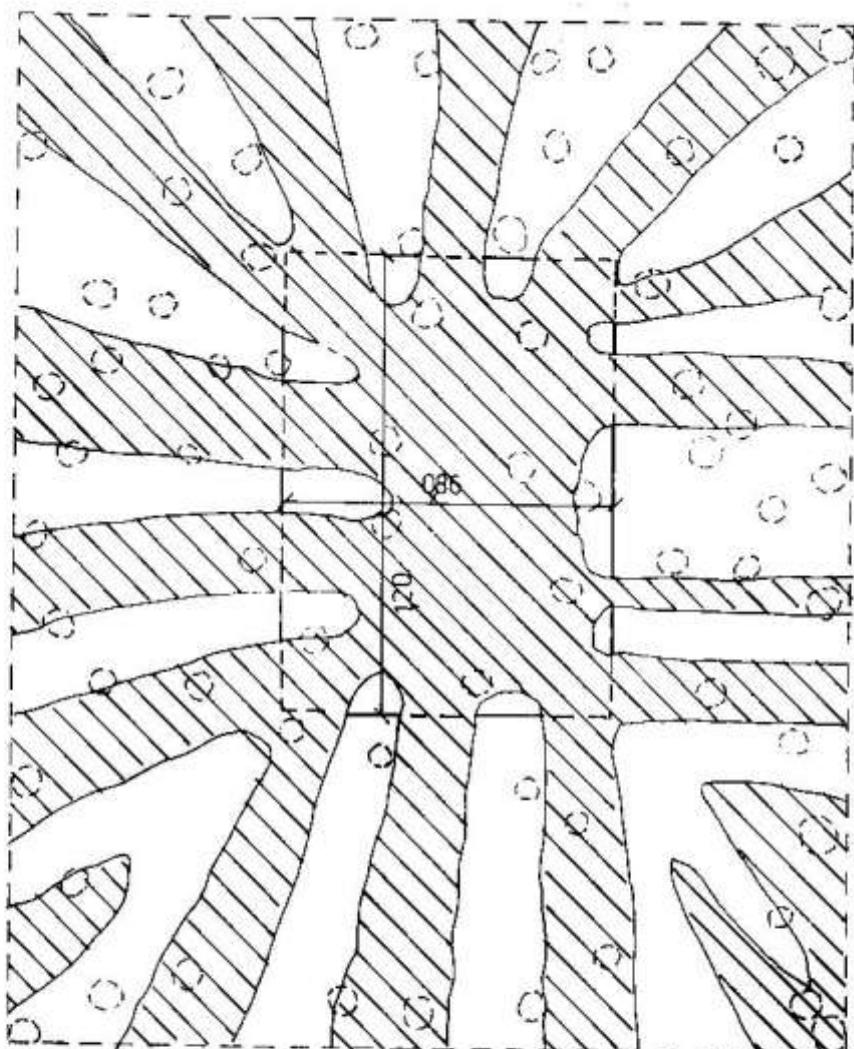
ESSAI DE RÉCONSTRUCTION DU FOUR DE TELITA.
